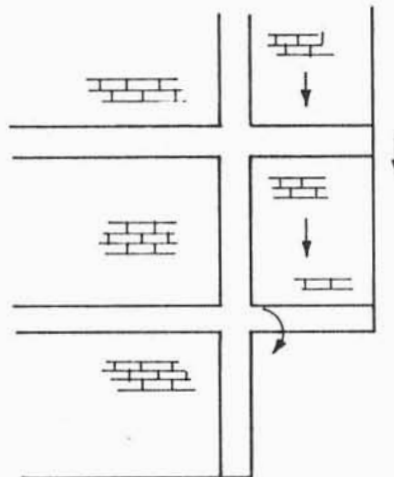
Transmissão de cargas de um balanço para o outro, por deformabilidade da laje.
